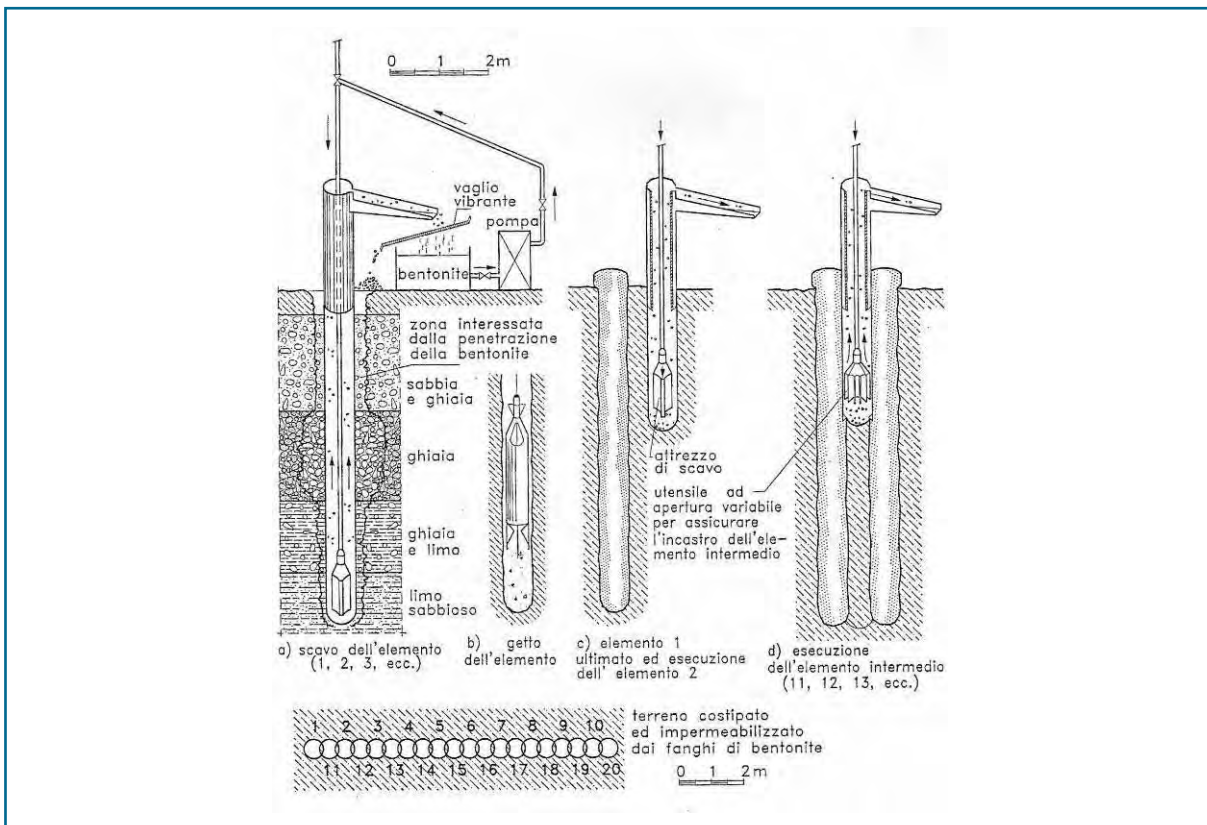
Costruzione di un diaframma con elementi circolari secanti [Da Deppo, 1996].
